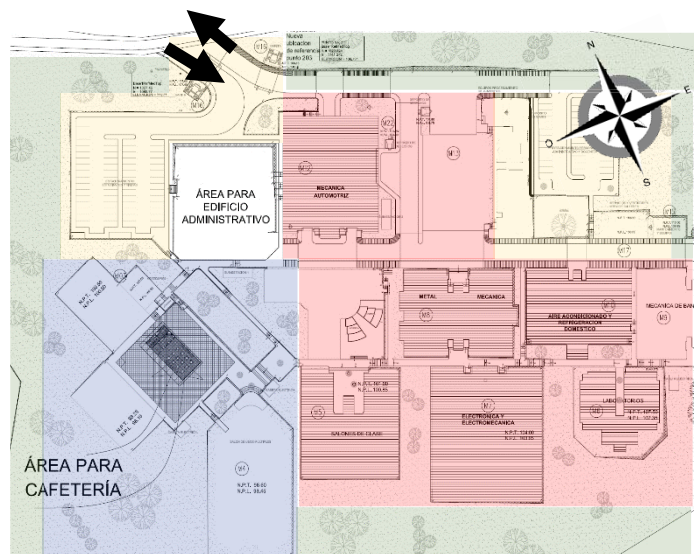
Zonificación actual del conjunto. Fuente: Elaboración propia a partir de plano proporcionado por dirección ITUGS. Plano original elaborado por David Baeza.
